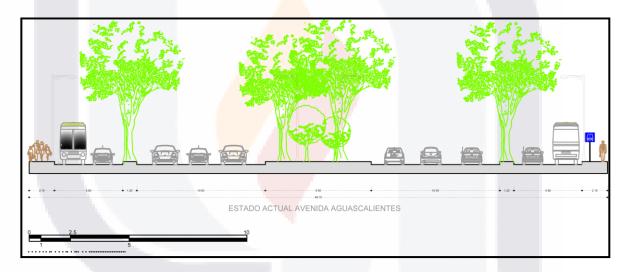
Sección transversal del estado actual de la Avenida Aguascalientes
